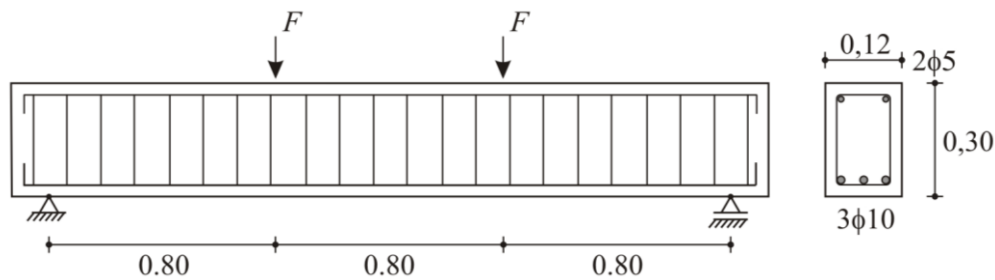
Exemplo 1: Viga bi-apoiada analisada (dimensões em metros).
